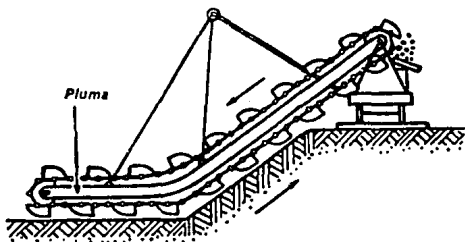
Excavadora con viga soporte que trabaja por debajo de su plano de apoyo.
